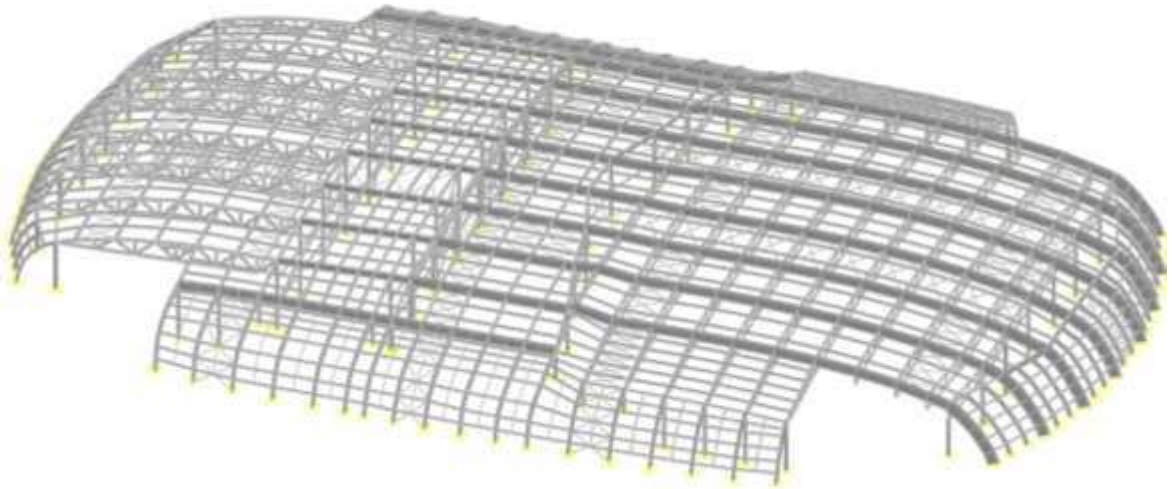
3Д модель расчетной схемы покрытия с учетом типов поперечных сечений
